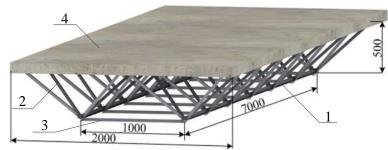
Схема исследуемой конструкции пролетного строения: 1 — нижний пояс ( $2 \sqcup 32 \times 3$  мм); 2 — раскосы ( $\square 25 \times 2$  мм); 3 — нижняя поперечина ( $\square 25 \times 2$  мм); 4 — железобетонная плита,  $\delta = 10$  см
